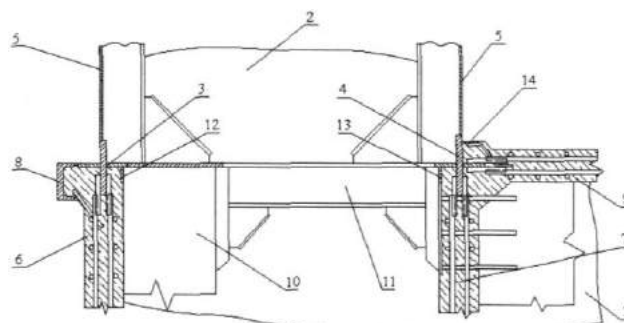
Конструктивный узел соединения металлической башни с железобетонным понтоном
